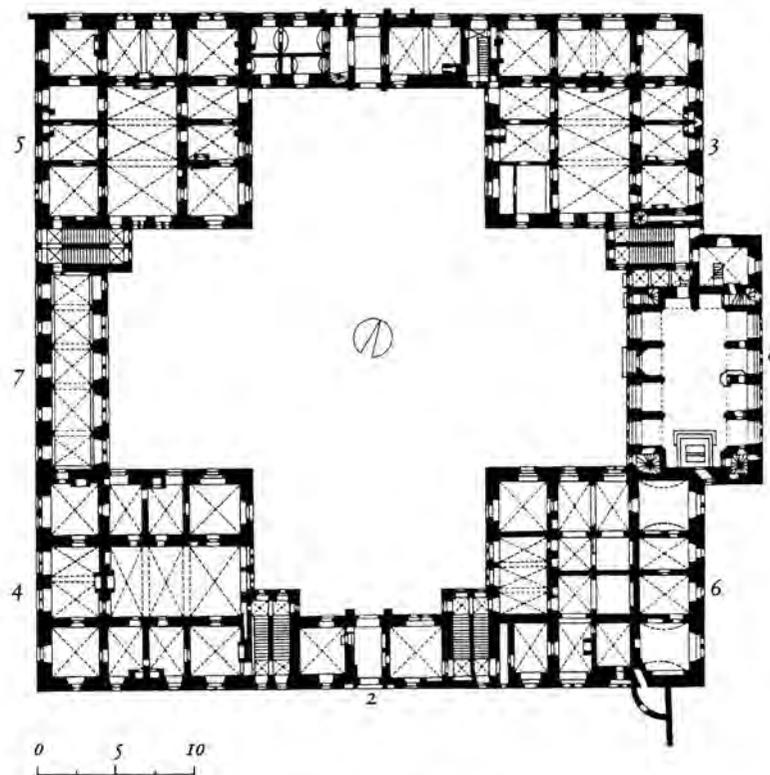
Schloss Augustusburg, Lageplan mit Gebäuden, aus /79/
